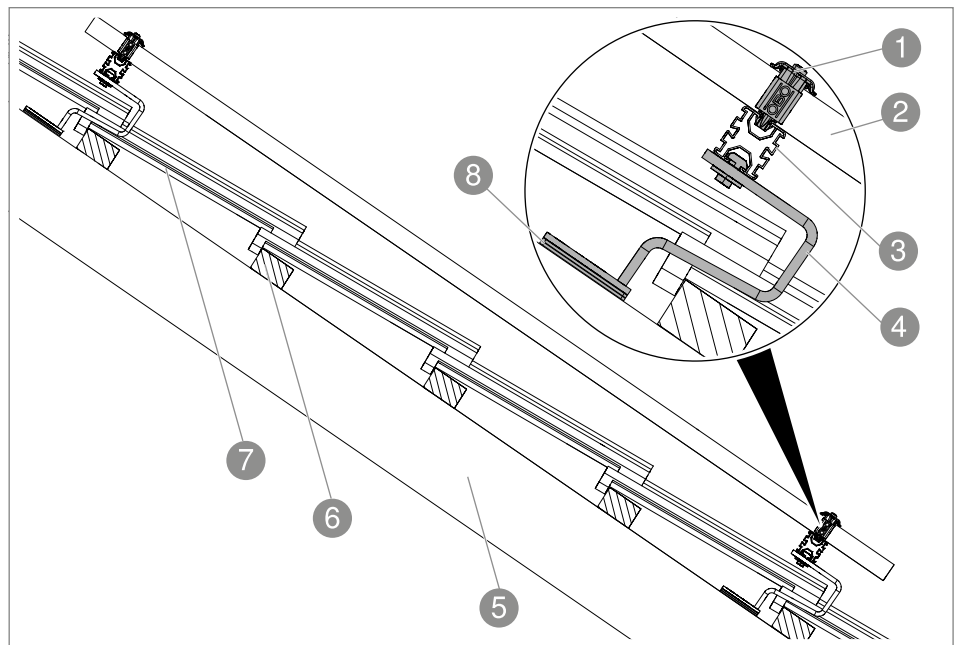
Systemaufbau Seitenansicht schwerer Dachhaken
